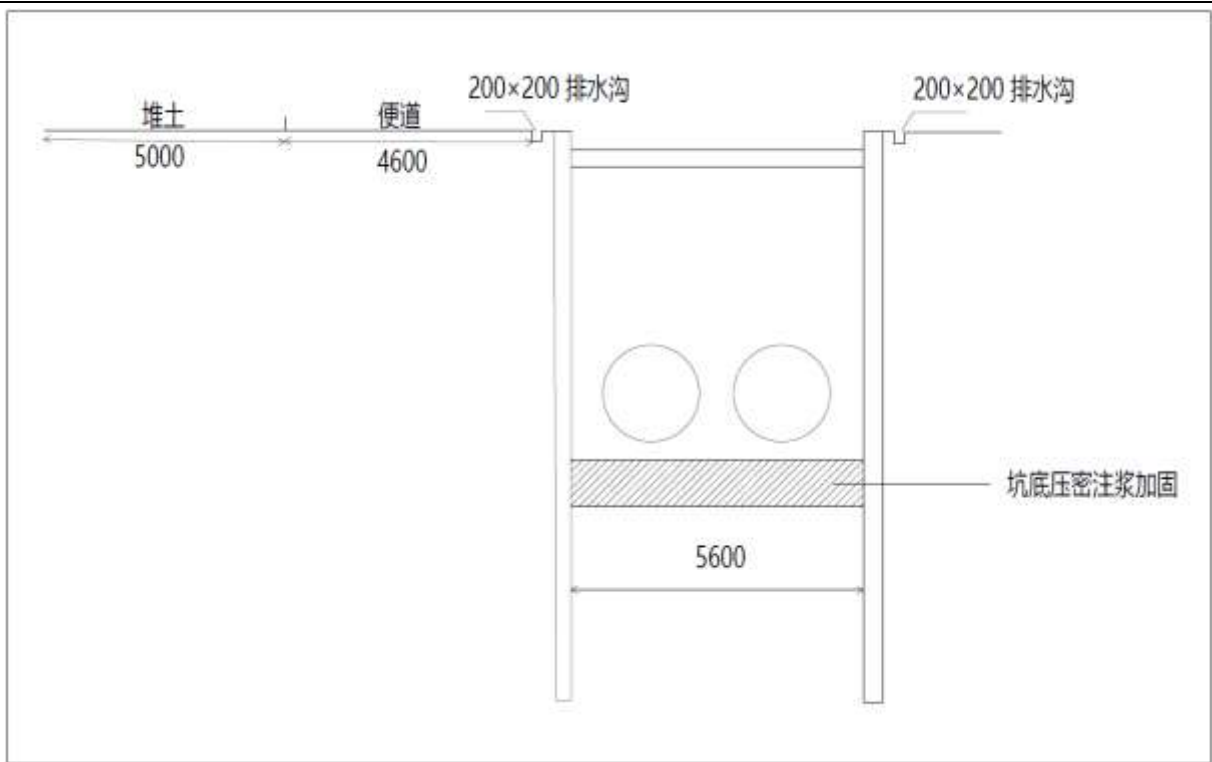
管沟作业带横断面布置示意图 (DN2000×2)
